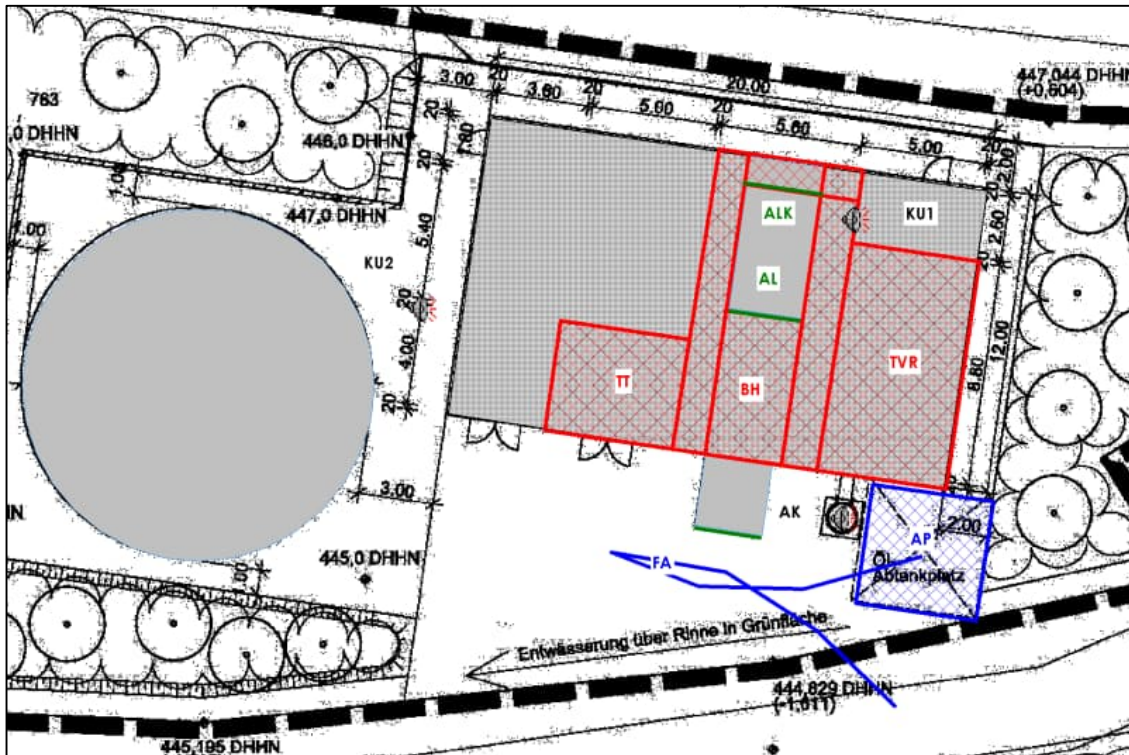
Lageplan mit Darstellung der relevanten Schallquellen
